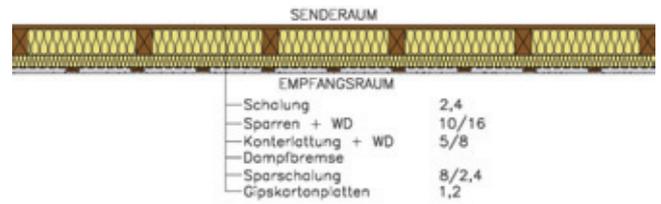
Holzdachkonstruktion mit Wärmedämmung
